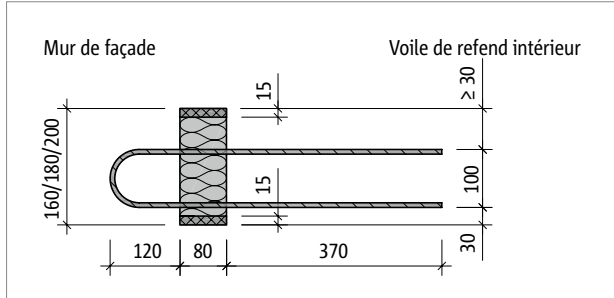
Schöck Rutherma® T type RF : vue en plan
